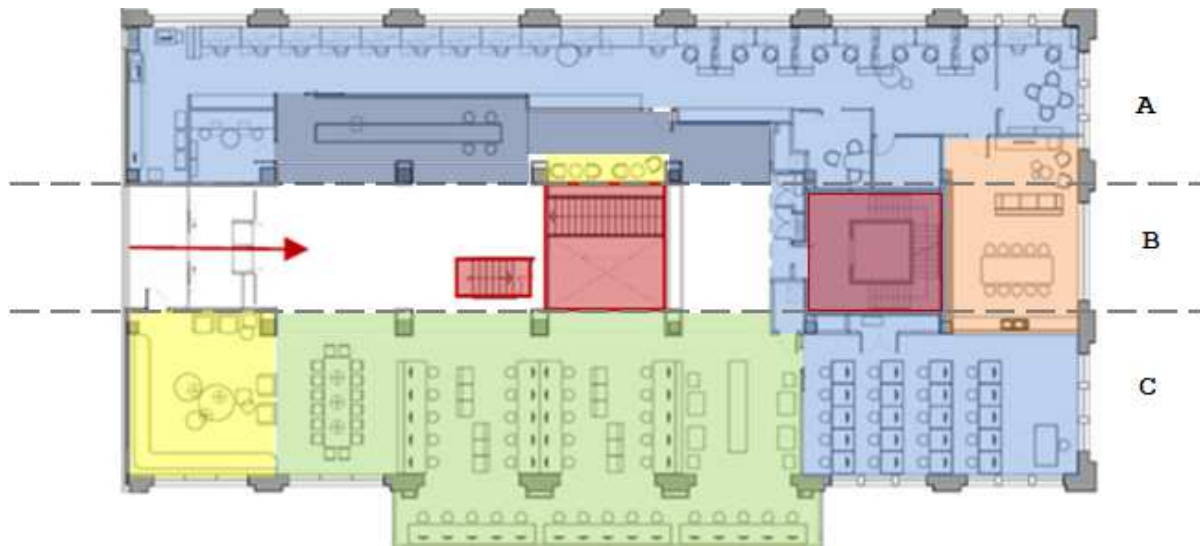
Planta baixa do pavimento térreo da Biblioteca Raheen.
